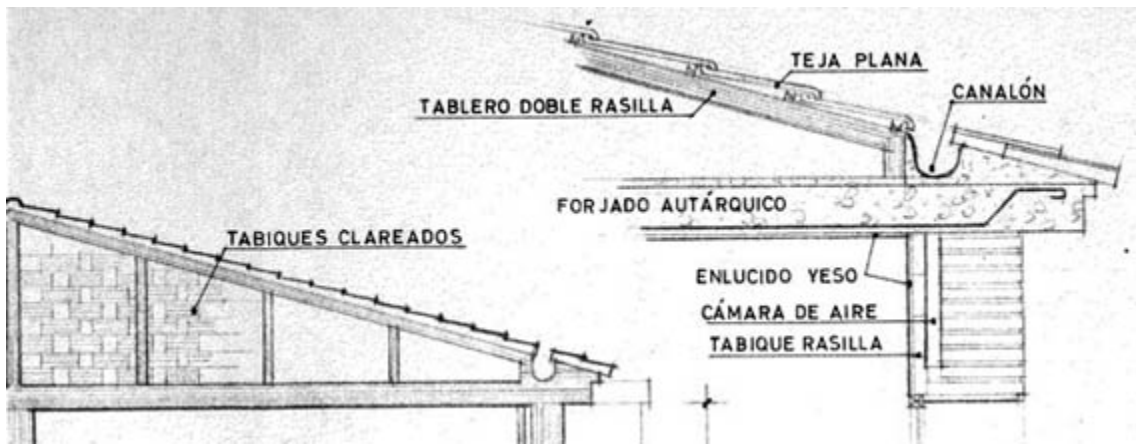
Detalle de cubierta tipo. Fuente: Archivo de la Villa de Madrid.
